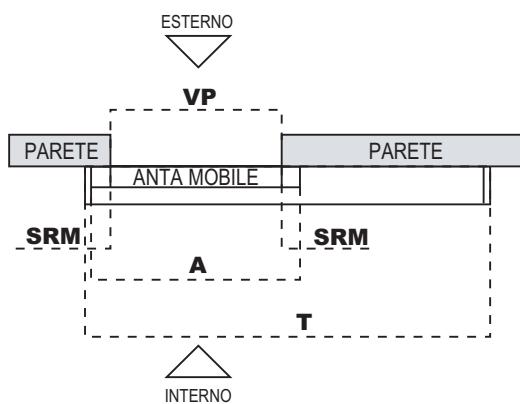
AUTOMAZIONE MONO-ANTA - CASO B : APERTURA A SINISTRA - MURO TRASVERSALE
